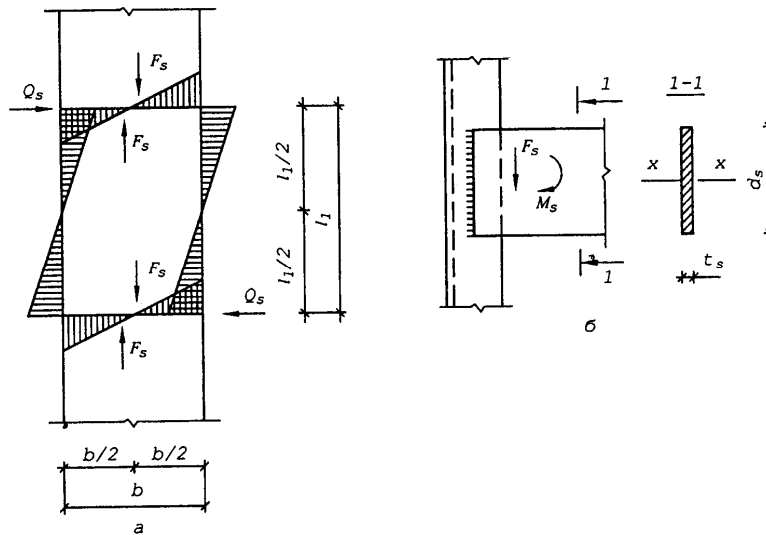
Розрахункові схеми наскрізної колони на планках: а – схеми до обчислення зусиль у планках; б – вузол кріплення планки до вітки колони
